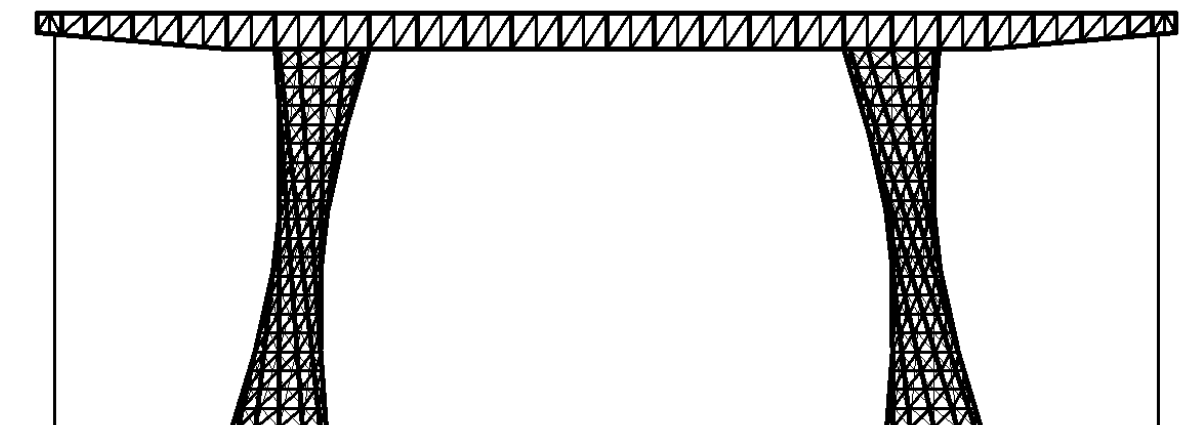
Вариант с опорами конструктивно выполненными сетчатыми оболочками
